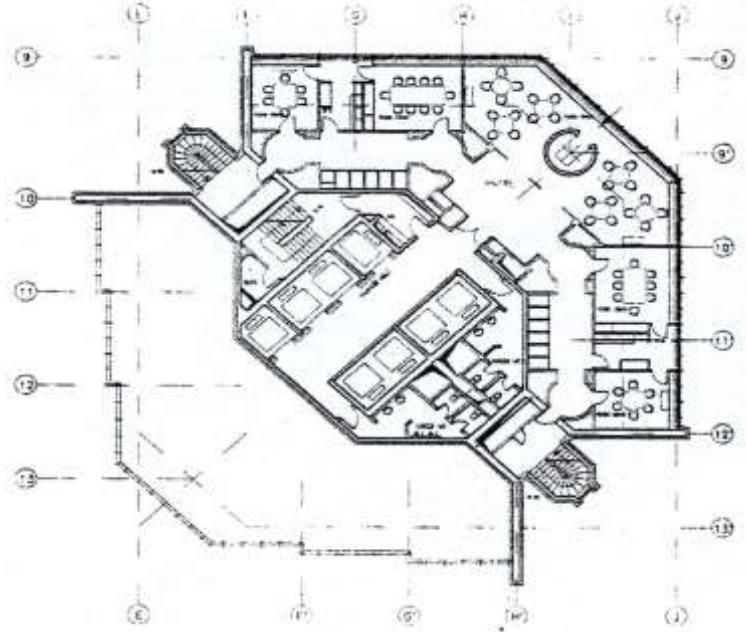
Sabancı Center giriş kat planı (Tümay, 1992).
